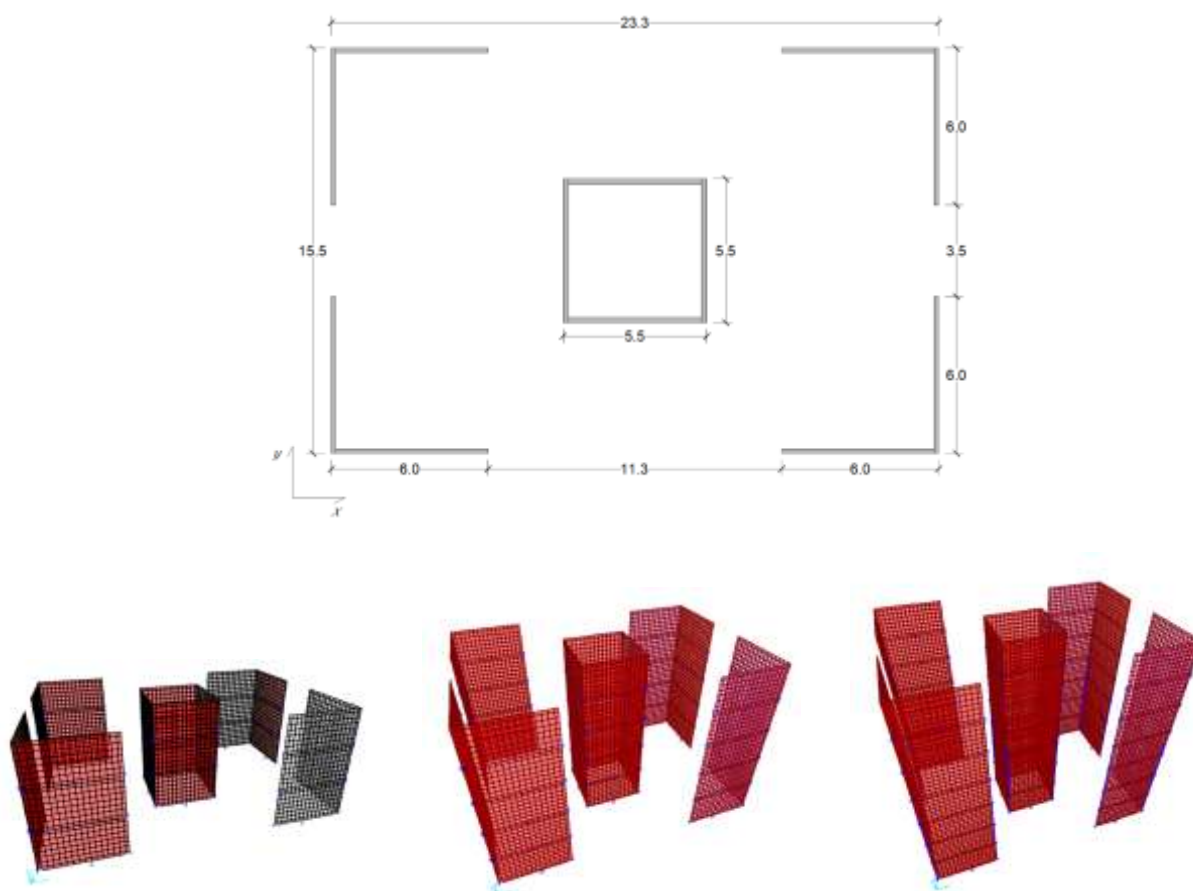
Pianta edificio caso studio e viste 3D edificio a 3 piani (sinistra), 5 piani (centro) e 7 piani (destra).
